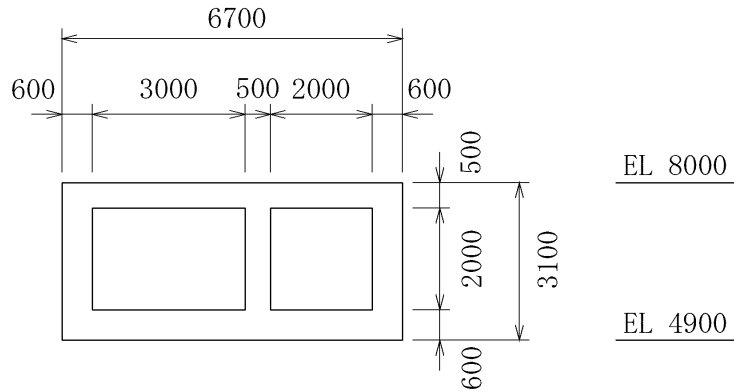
(1) 屋外配管ダクト (タービン建物～排気筒) 断面図 (A-A 断面)
